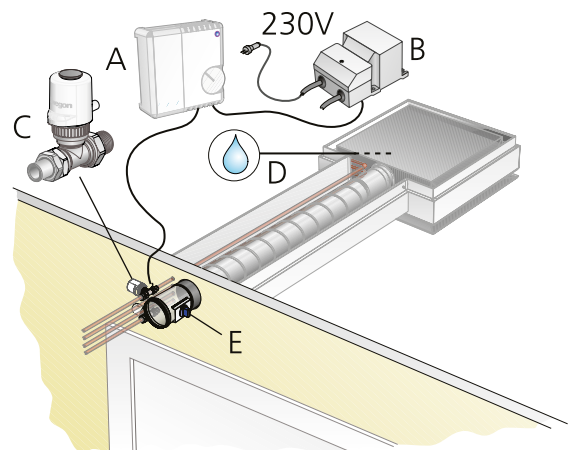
Installation mit Ventil, Stellantrieb und Klappe im Korridor
